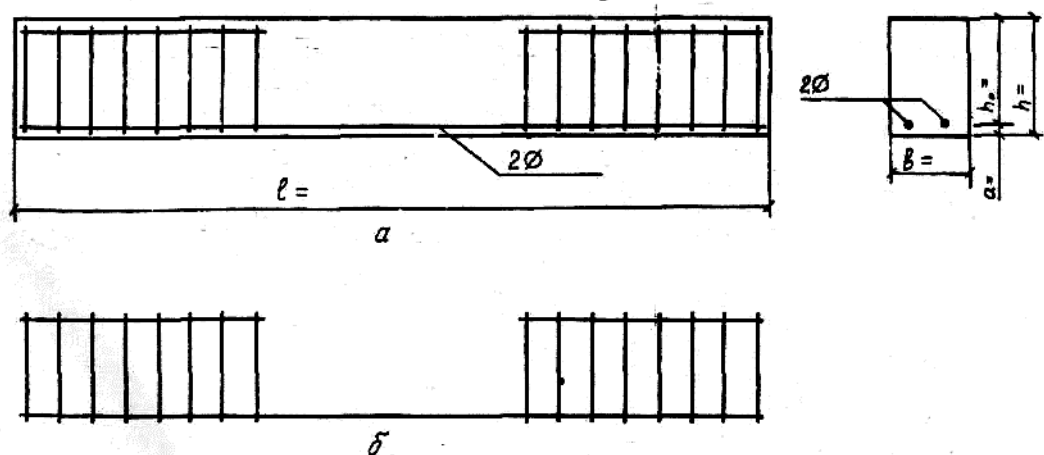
Геометрические размеры (а) и схема армирования балки (б)
